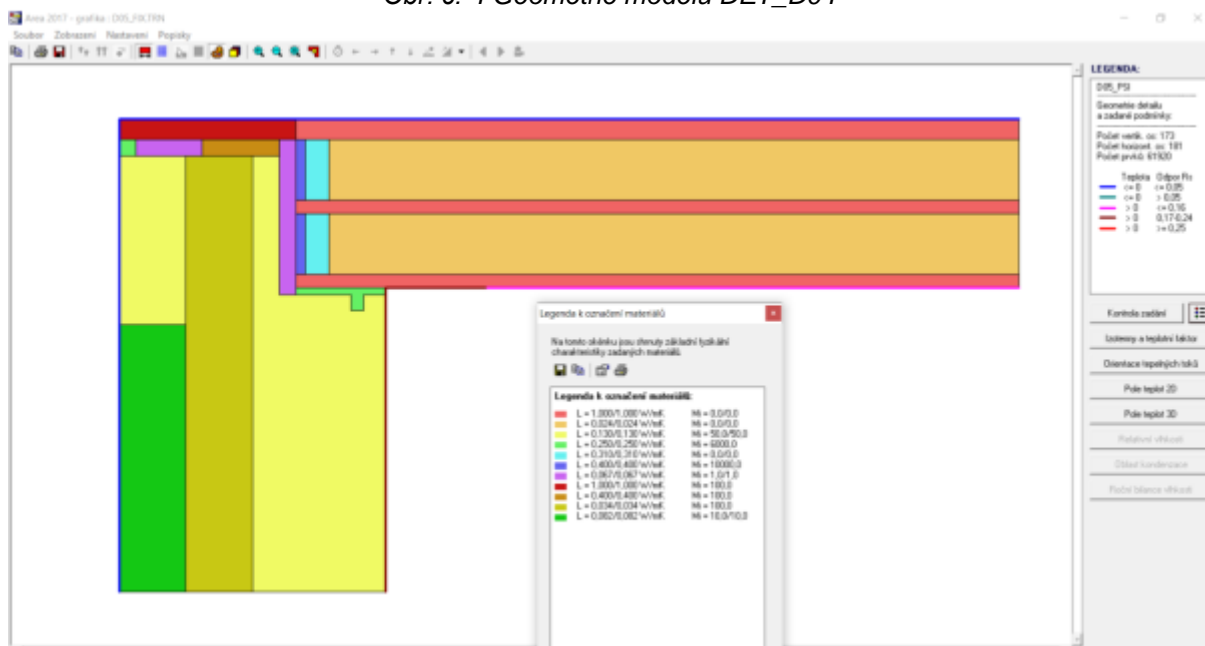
Geometrie detailů – okno otevíravé nad střešní plášť
